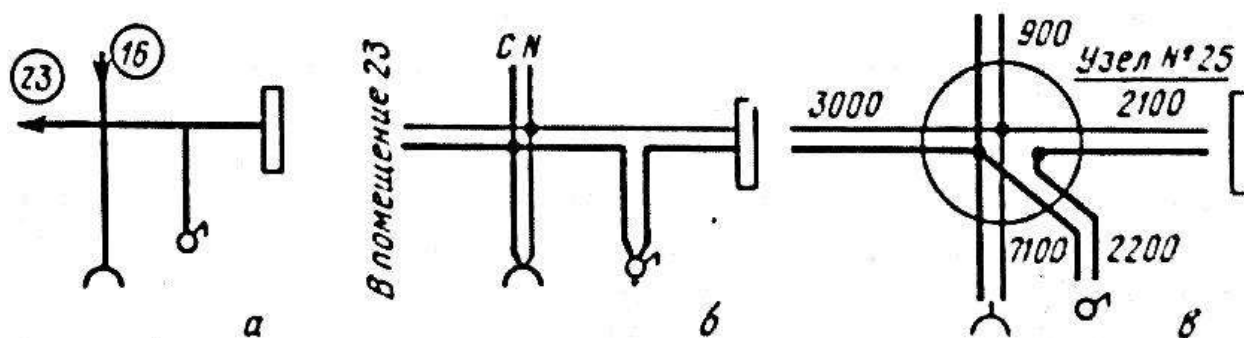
Схемы соединения осветительной электропроводки в узле № 25: а - однолинейная; б - многолинейная; в - соединение проводов в узловой коробке.
